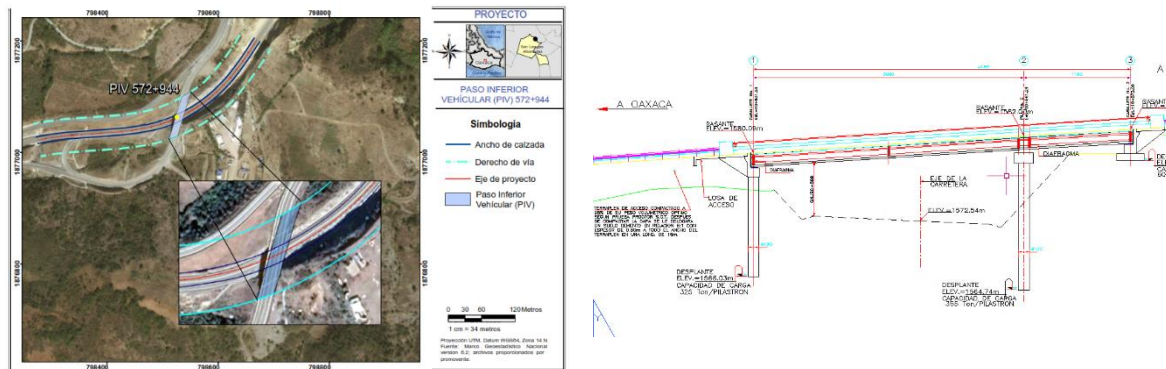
Proyecto en planta y corte longitudinal del PIV 572+944.
